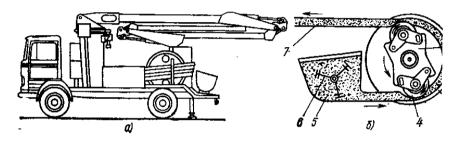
Автобетононасос: а – общий вид; б – схема работы беспоршневого бетононасоса
